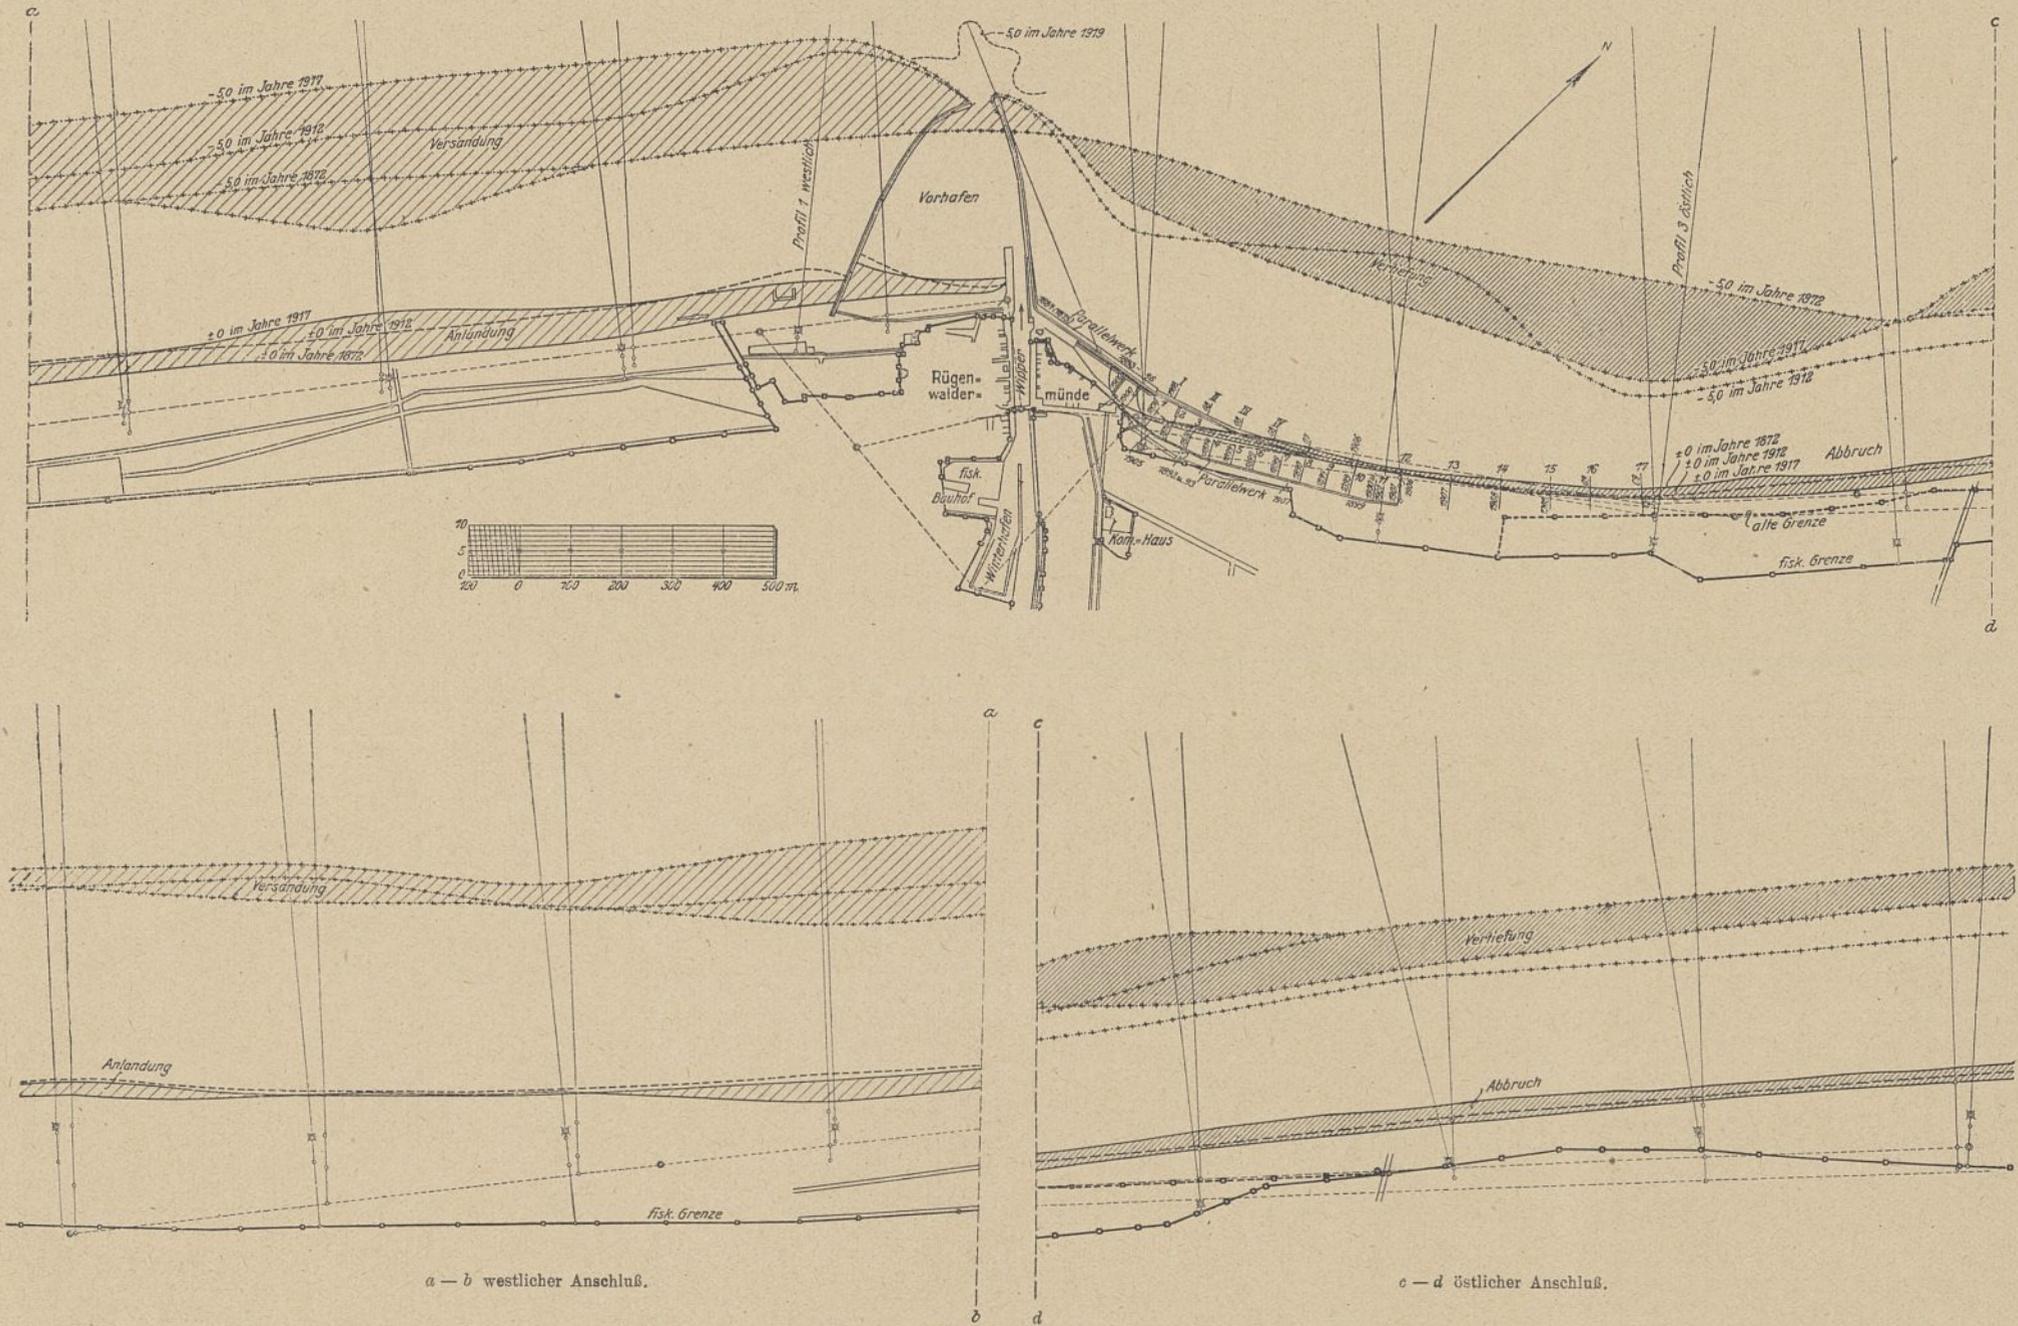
Lageplan des Hafens zu Rügenwaldermünde.
